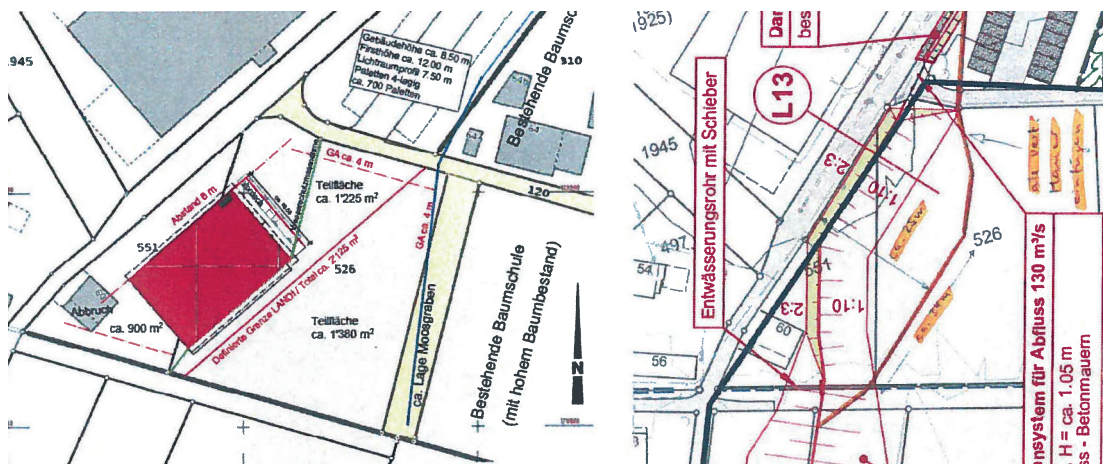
Projektidee LANDI und mögliche Dammführung im Vergleich zum Wasserbauplan (Quelle/Stand: Unterlagen zum Wasserbauplan, November 2013⁴)
